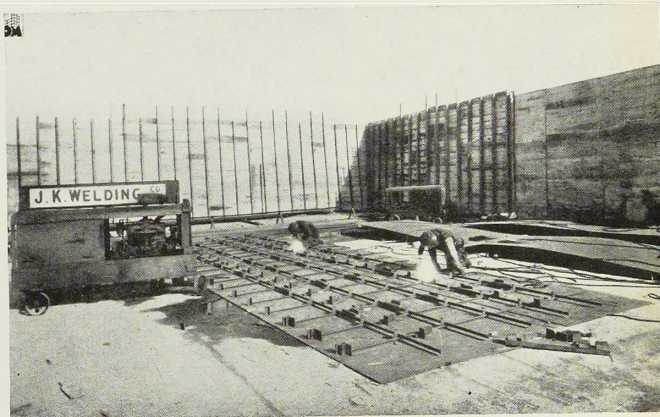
Vue de l'ossature d'un des réservoirs. Tous les assemblages ont été faits par soudure.
